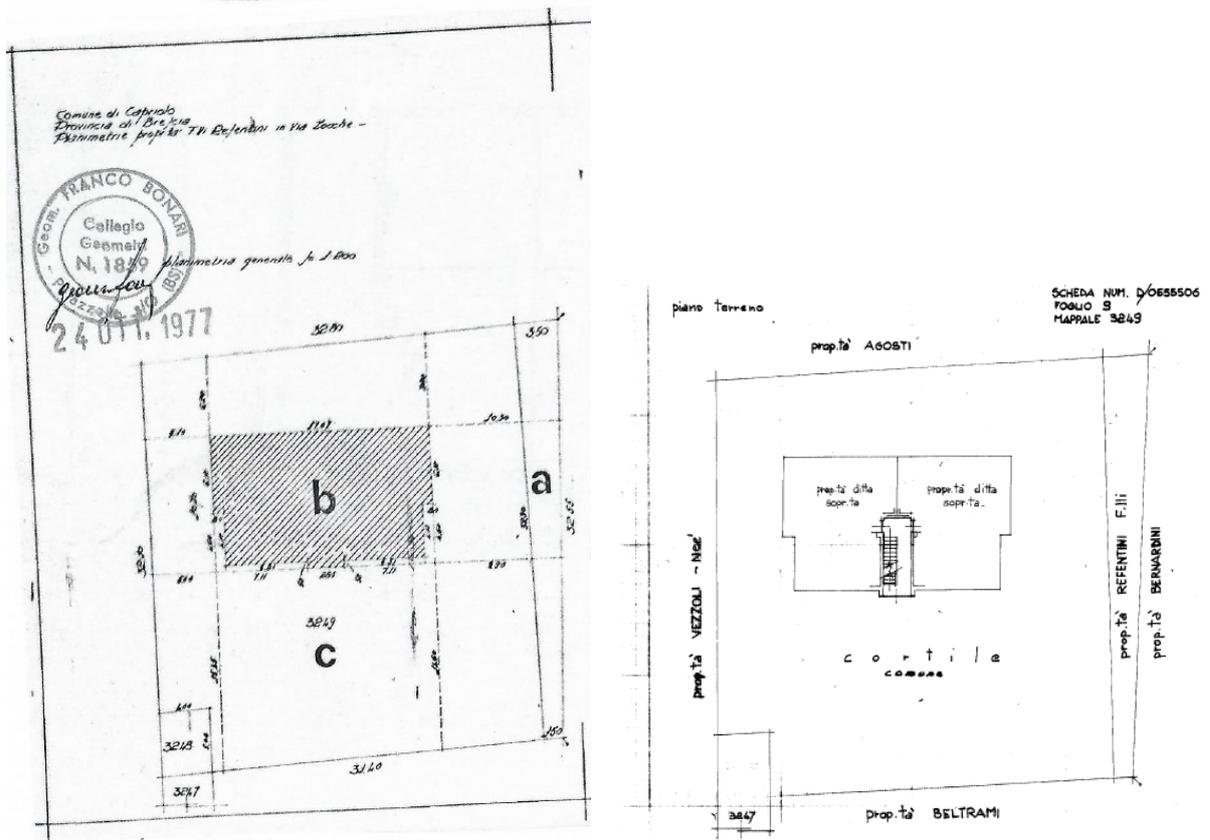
planimetria immobiliare agli atti rispettivamente presso Comune di Capriolo e presso il Catasto
